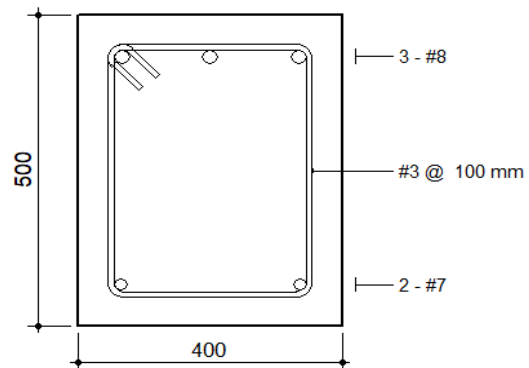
Sección de viga interior plantas 1, 2, 3 y 4. Fuente: Propia.
